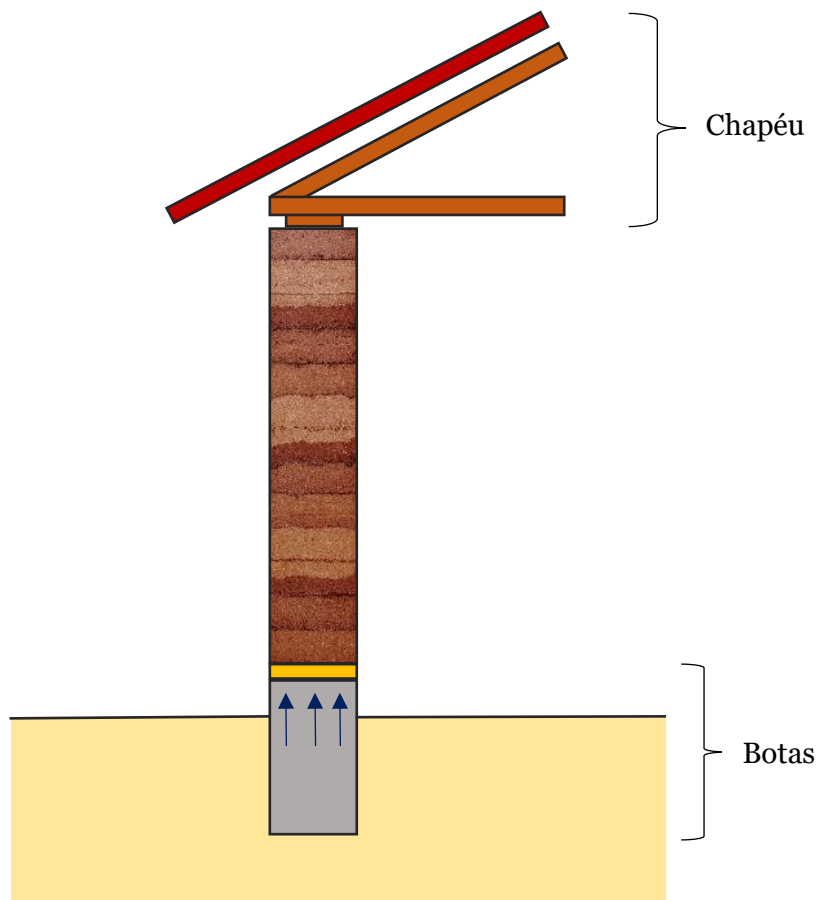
Corte esquemático das “botas e do chapéu”. Representação da proteção das paredes através da cobertura, embasamento e barreira capilar (retângulo a amarelo). Autora, 2025
